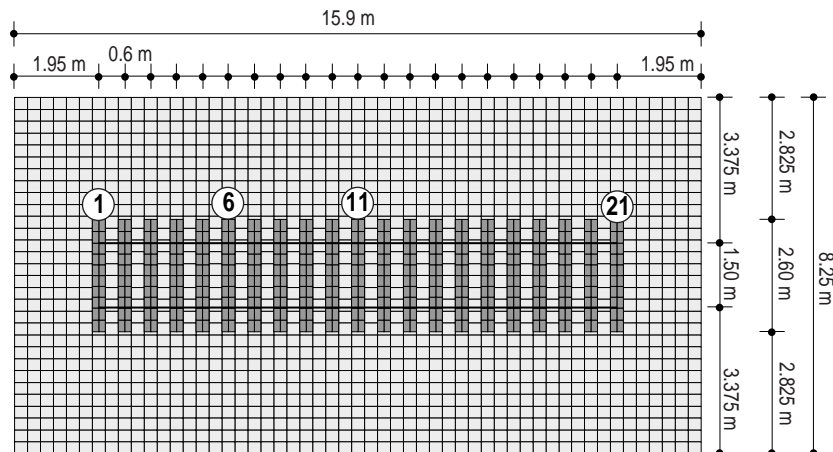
Grundriß des Gleissystems mit Baugrundausschnitt
